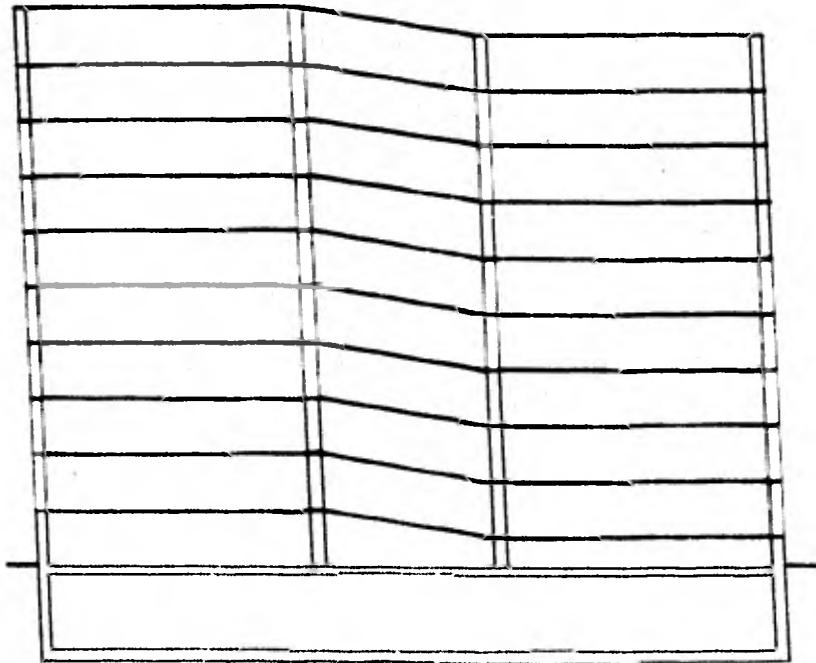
Corte esquemático transversal del edificio. Solución prefabricado.
